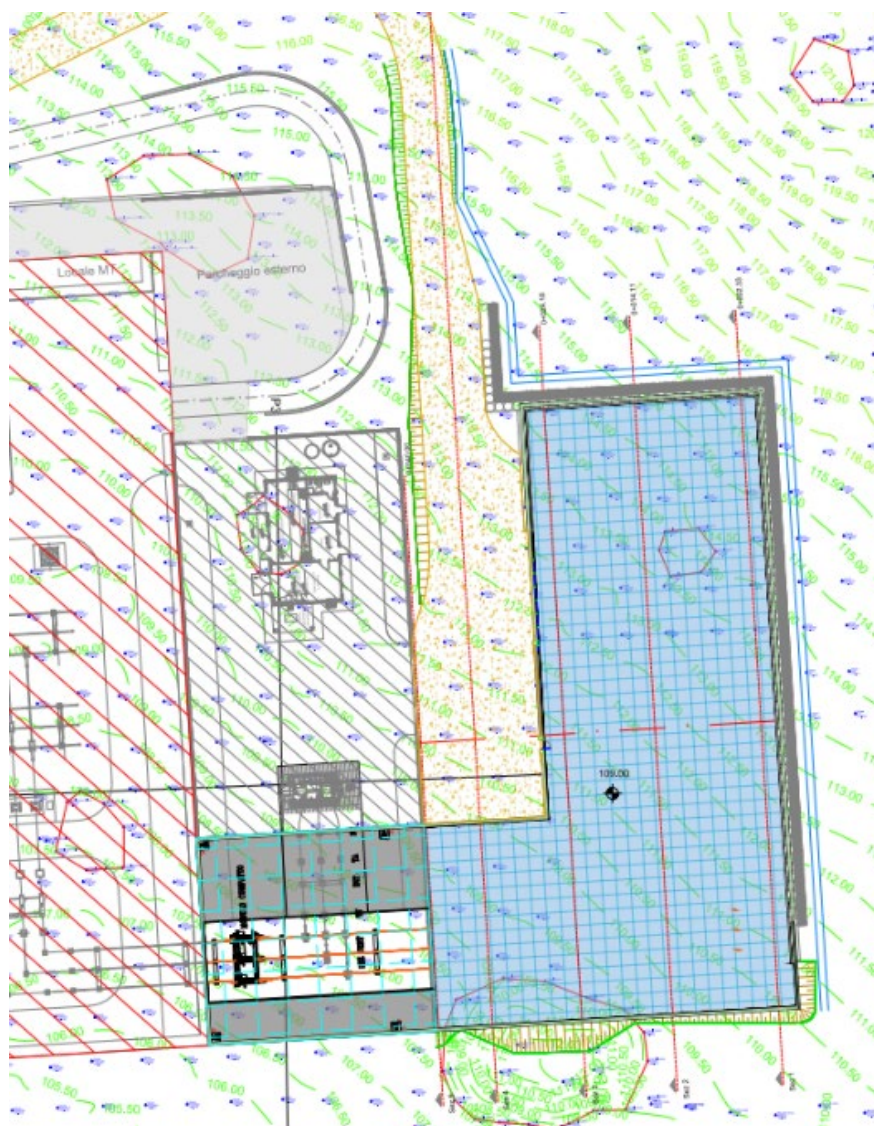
Stralcio plano-altimetrico impianto utenza⁵²
